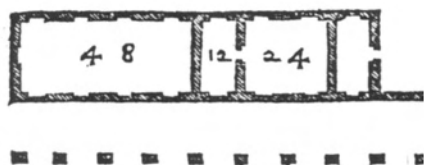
Ala de serviço em duas faixas, Villa Emo. Fonte: Palladio, 1570.
